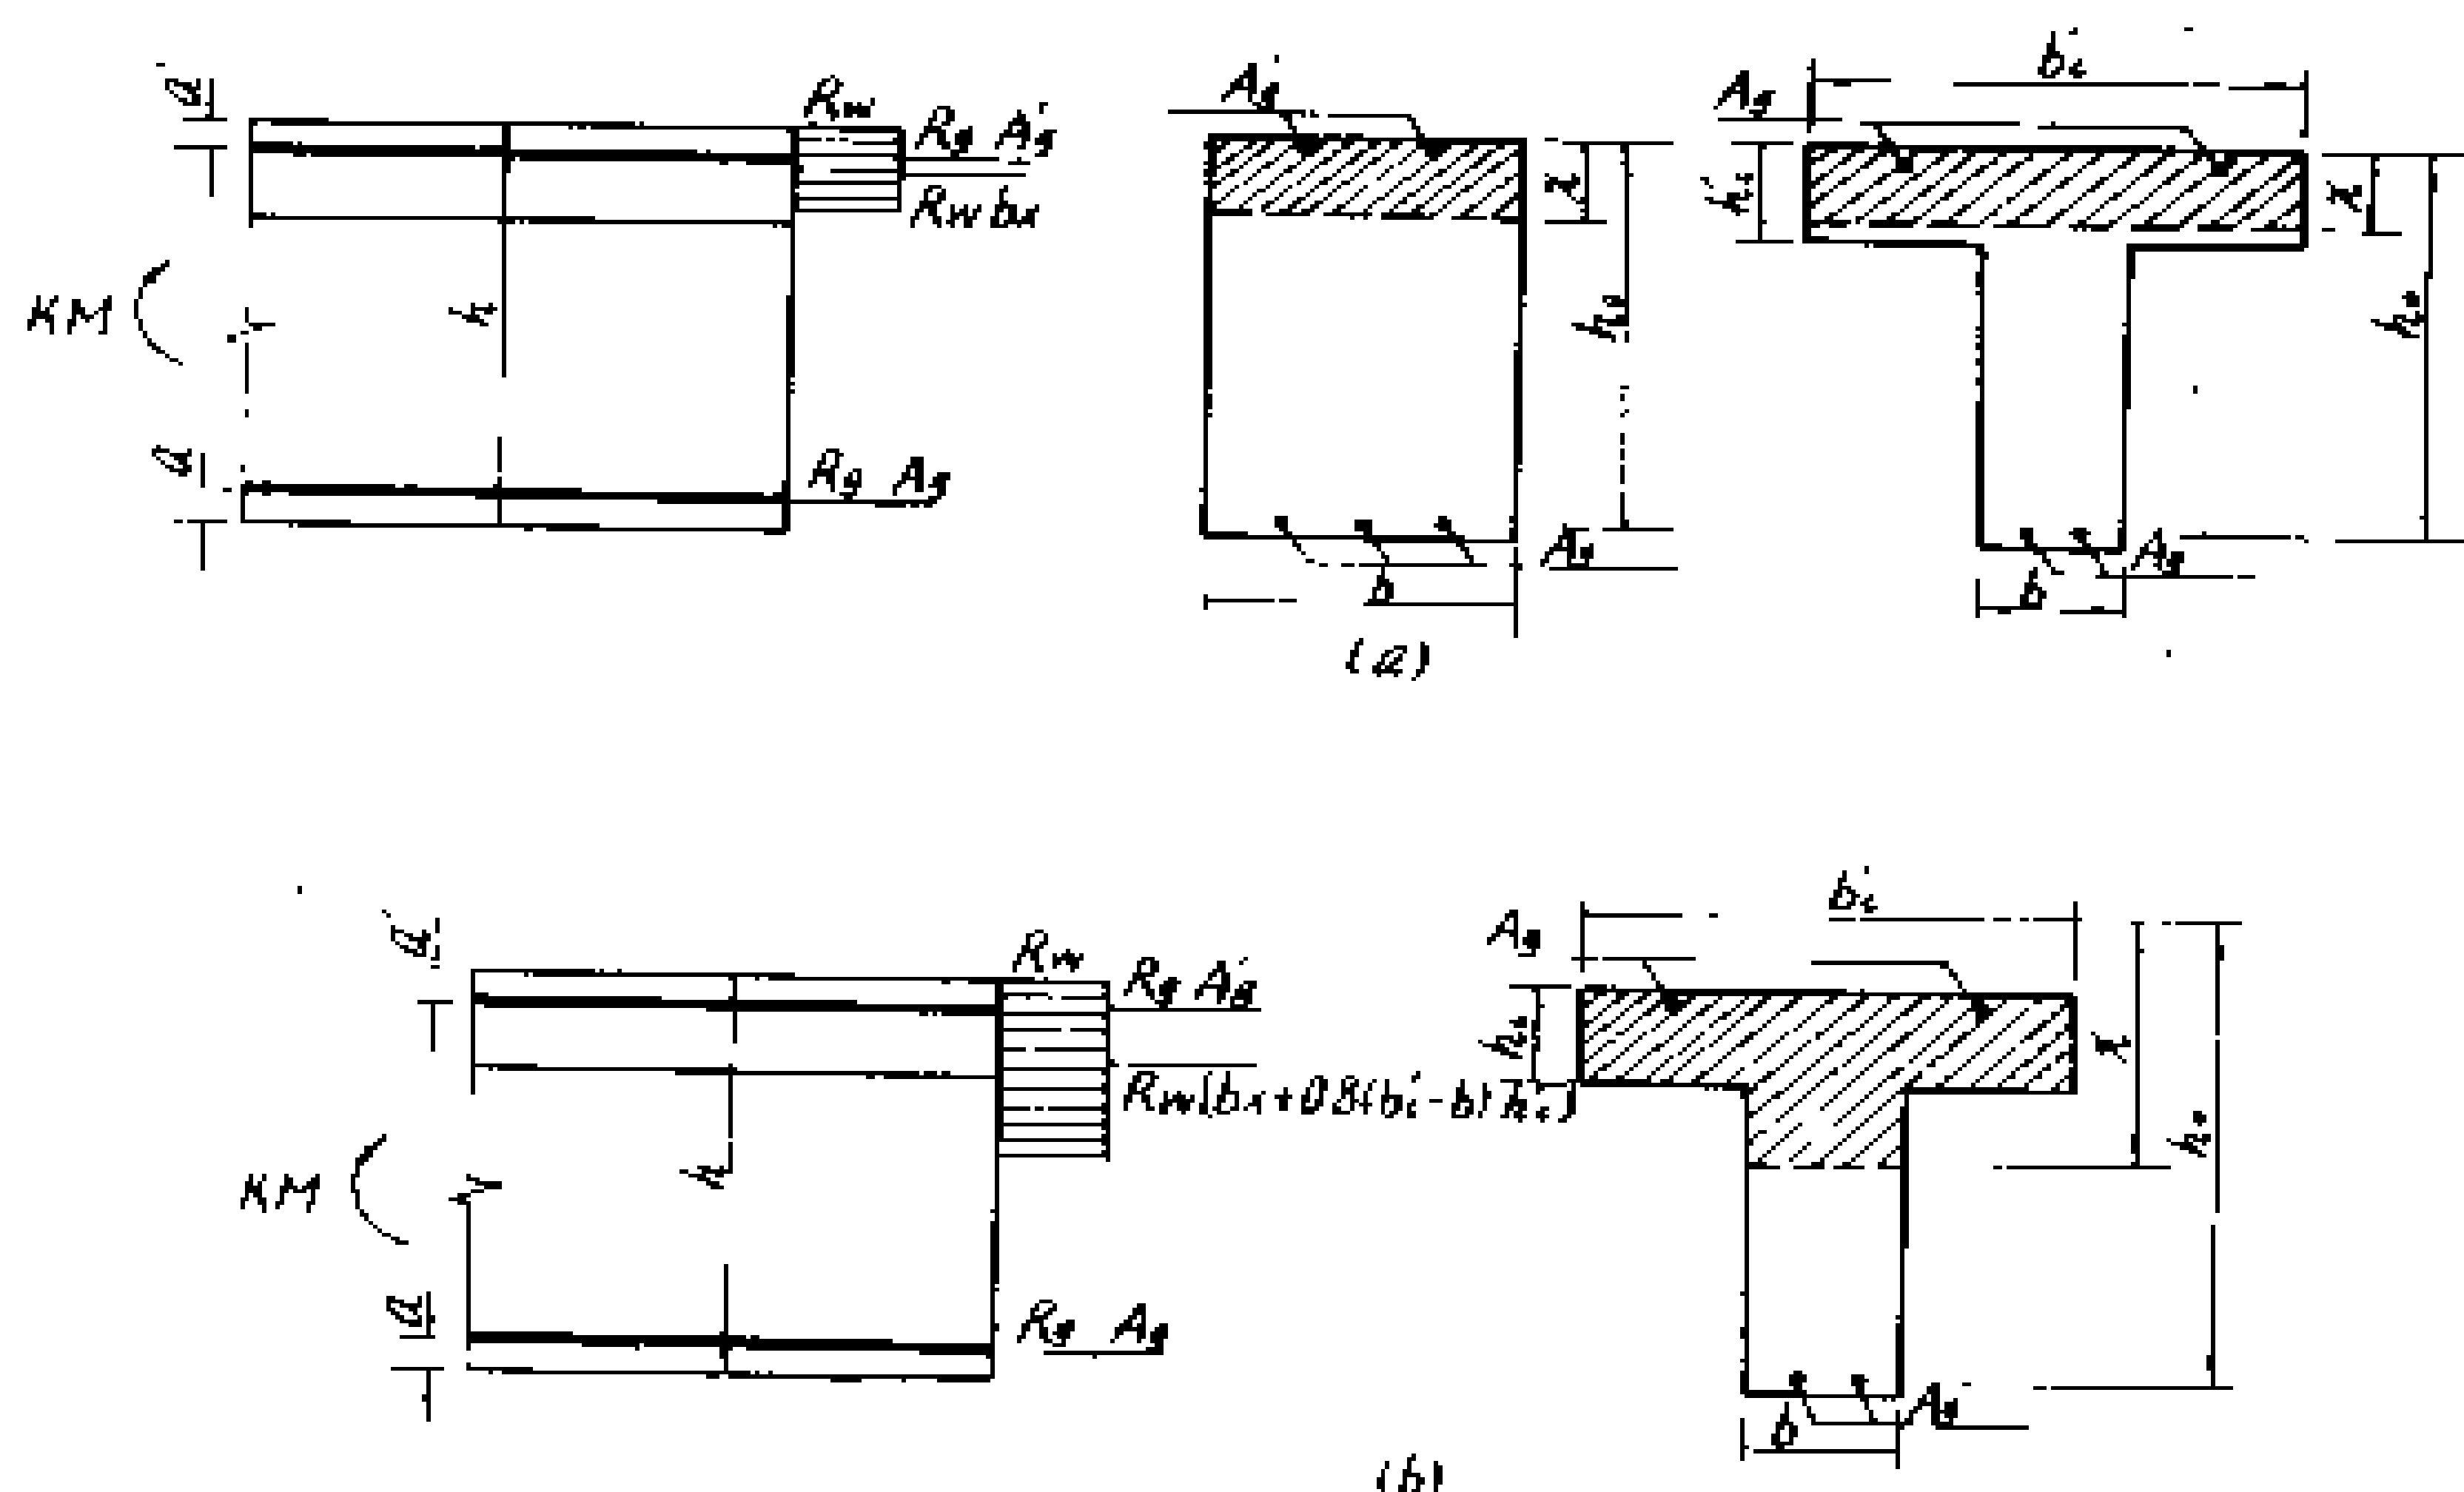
钢筋混凝土受弯构件截面强度计算图
